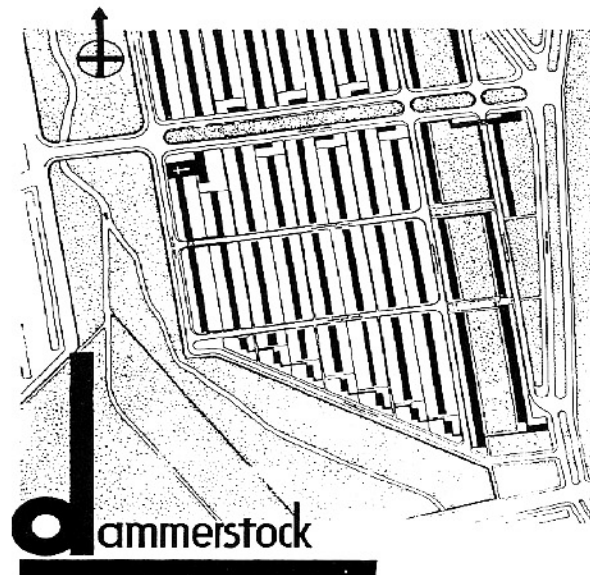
Planta general de la Siedlung Dammerstock, 1927-1929
